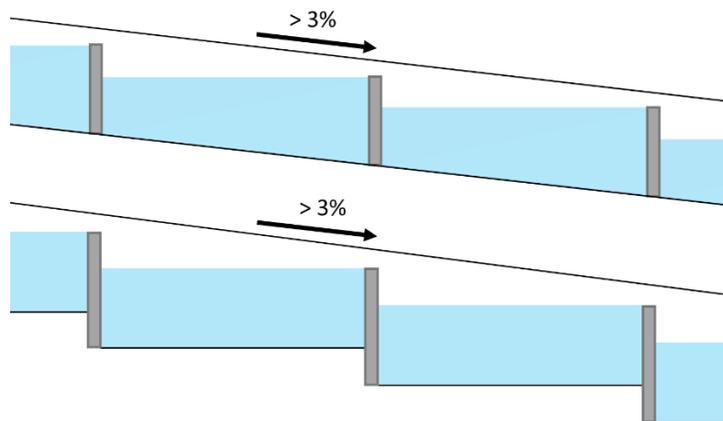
Ejemplo de cómo aterrizar la base del pavimento permeable.
